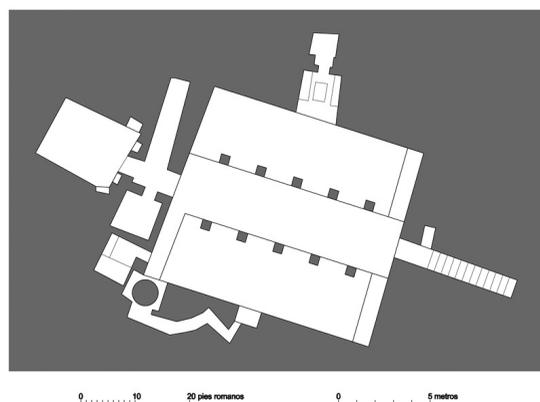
Planta hipotética del mitreo del elefante. Elaboración propia.
